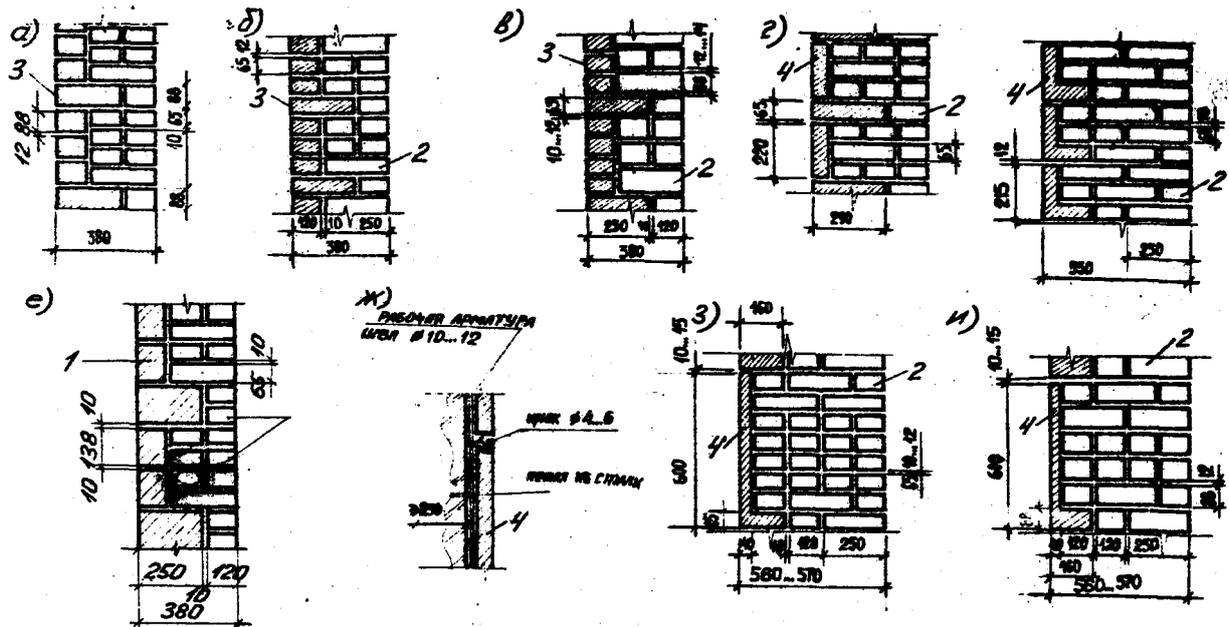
Кирпичные стены с облицовкой: а) - в) - лицевым кирпичом; г) - плоскими плитами; д), е), и) - закладными плитами из бетона; е) - лицевыми керамическими камнями; ж) - узел крепления облицовки плитами из естественных камней: 1 - лицевой керамический камень; 2 - кирпич; 3 - лицевой кирпич; 4 - плита облицовки
